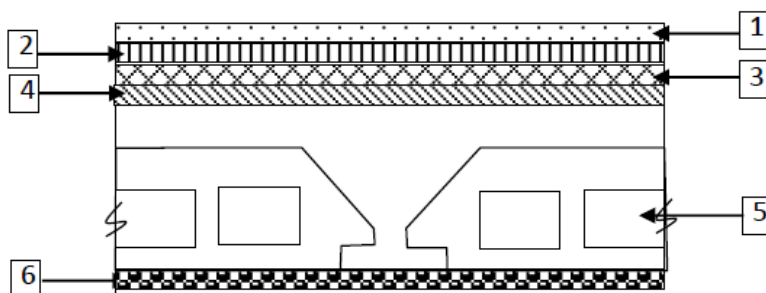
Coupe transversale d'un plancher terrasse accessible.
